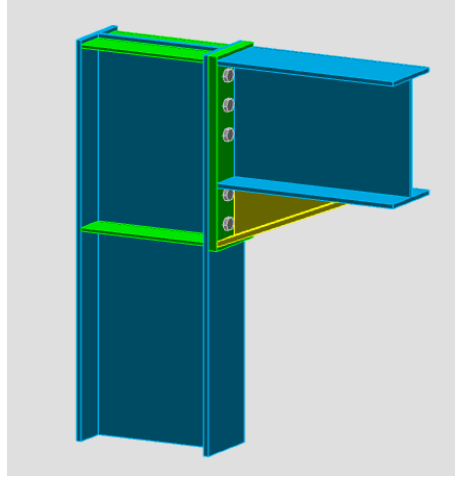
Schéma d'assemblages poteau-poutre
